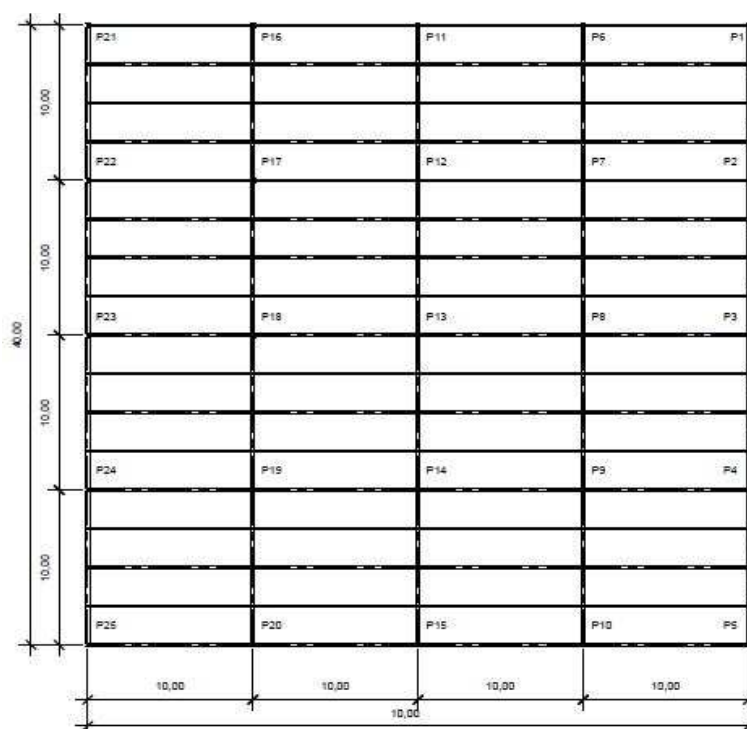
Planta baixa do modelo estrutural do edifício em estudo (dimensões em m) [1].
